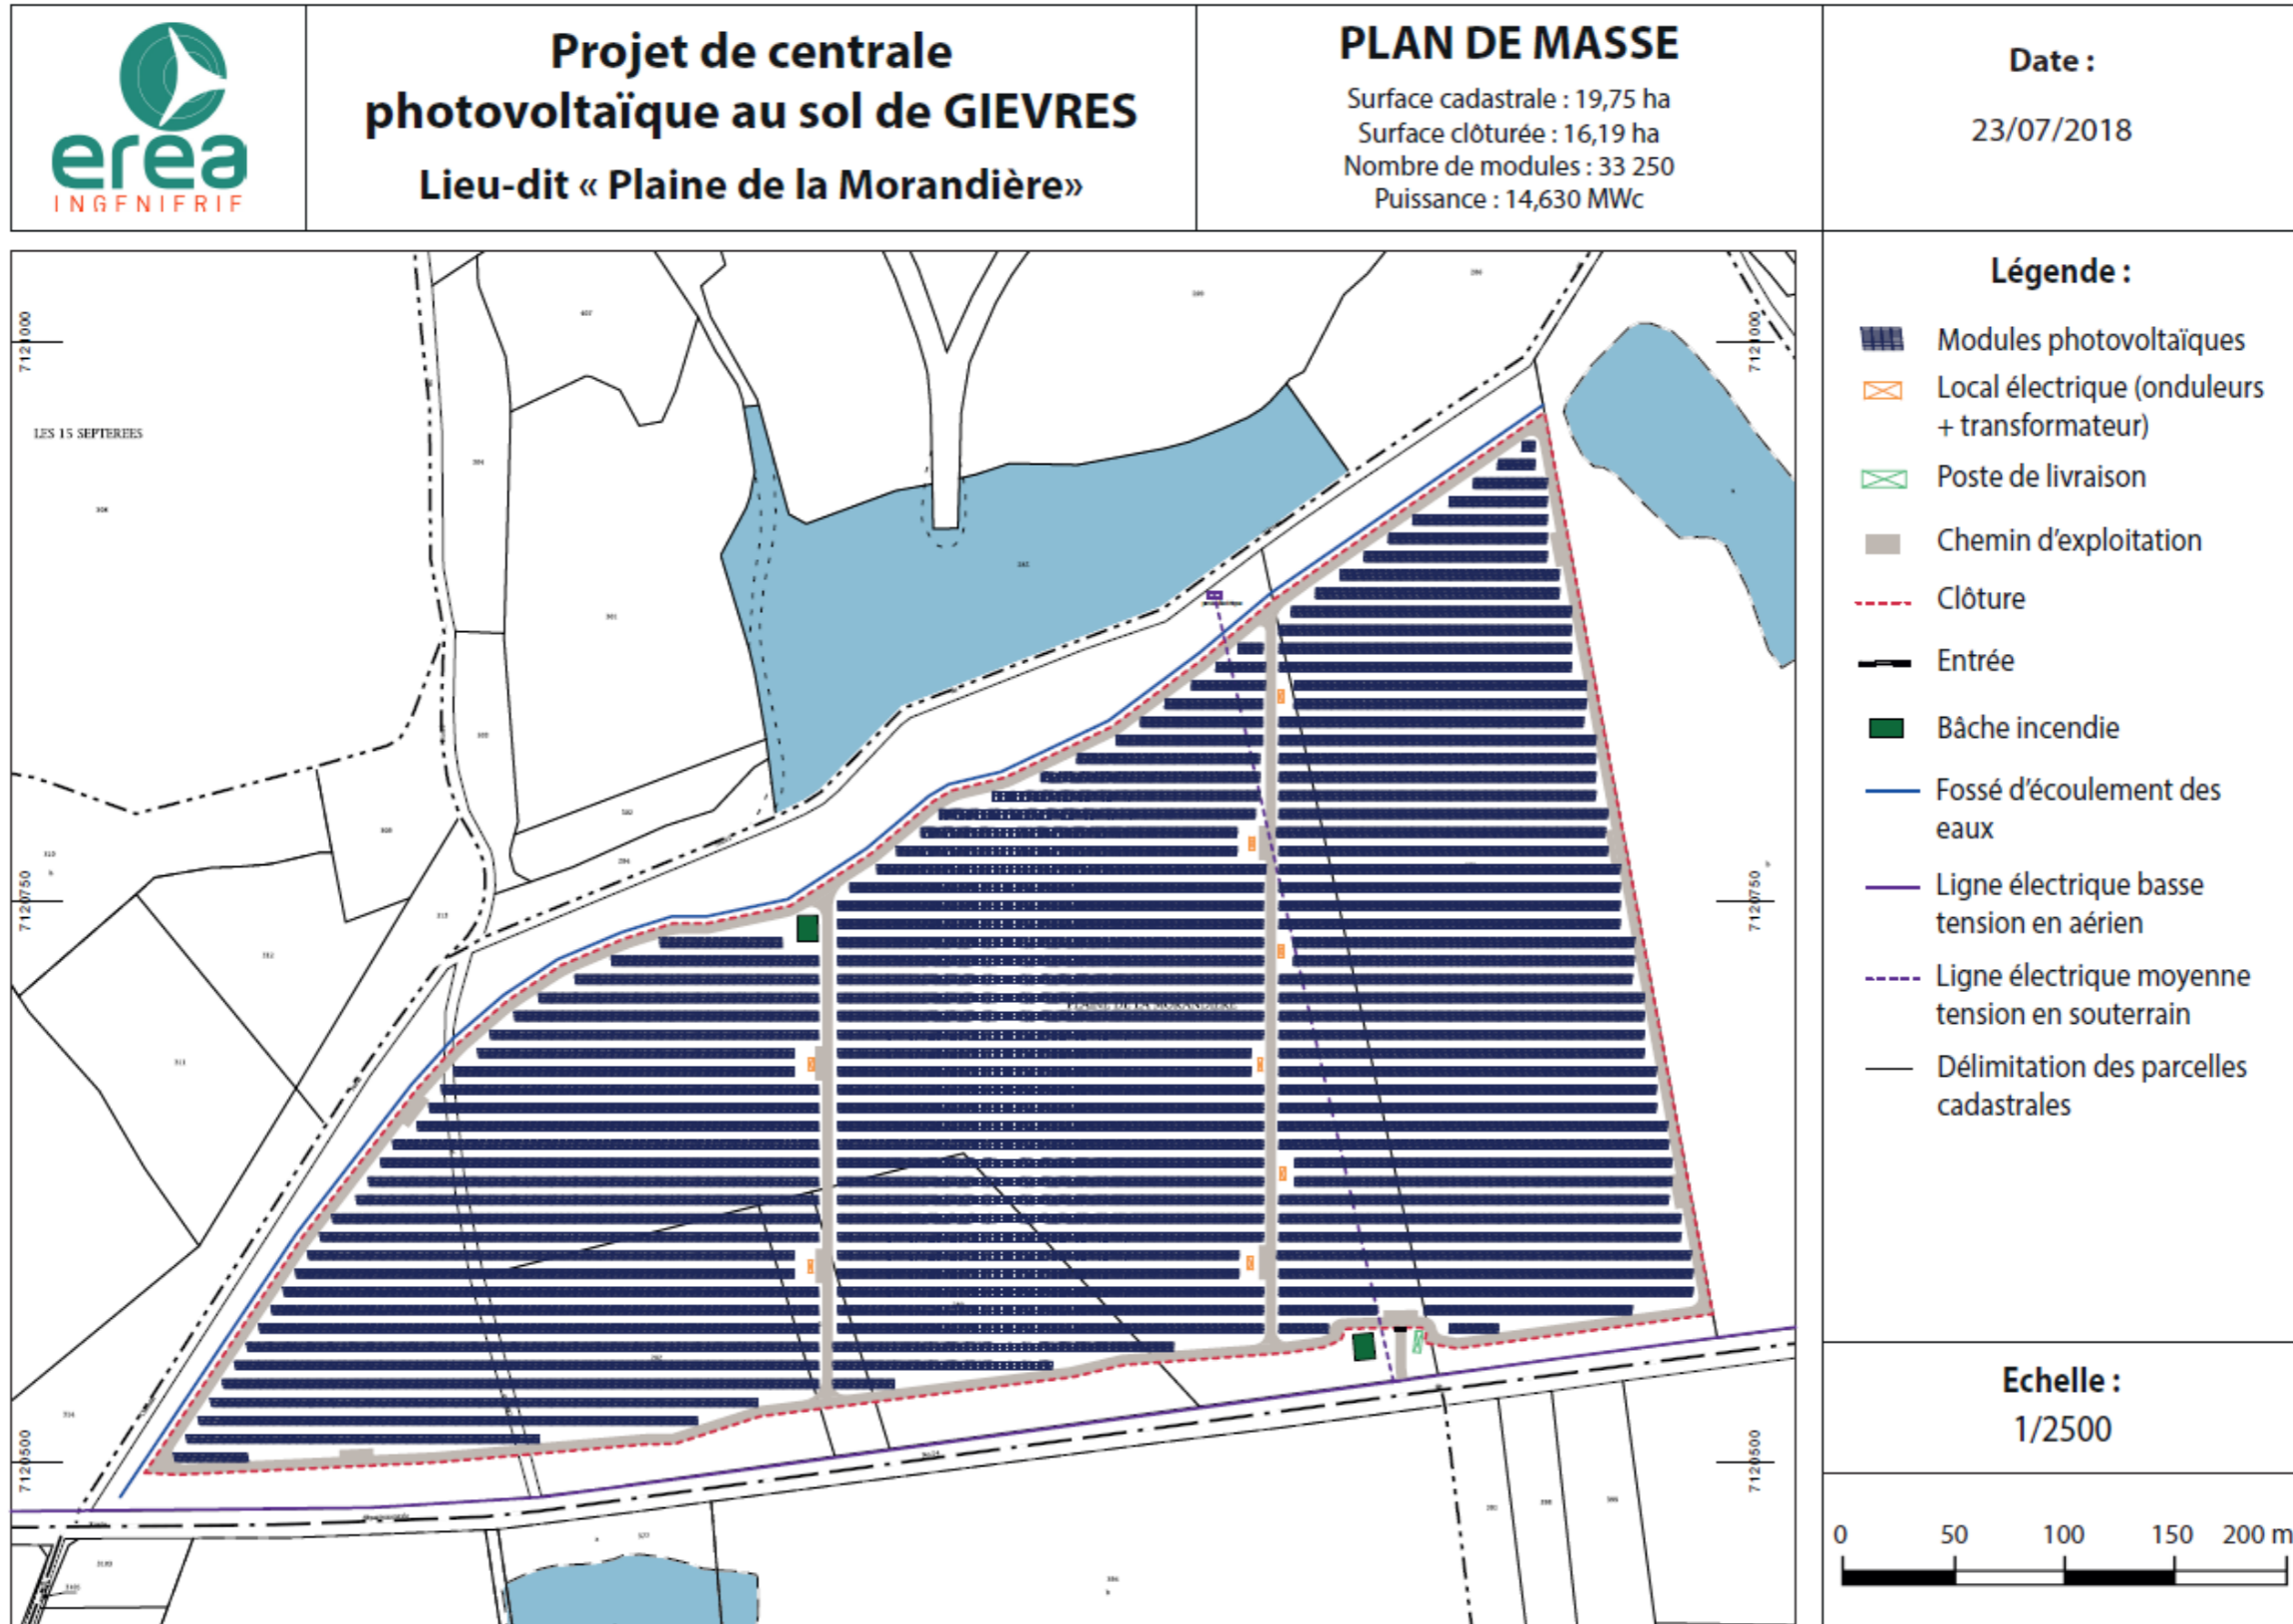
Plan de masse (source : EREA INGENIERIE - Juillet 2018)
